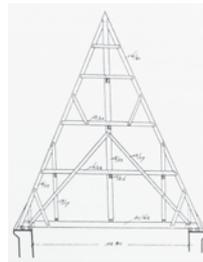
, Ehemalige Dachkonstruktion Dom, Frankfurt am Main, gehängter Dachstuhl mit Hängesäule.
